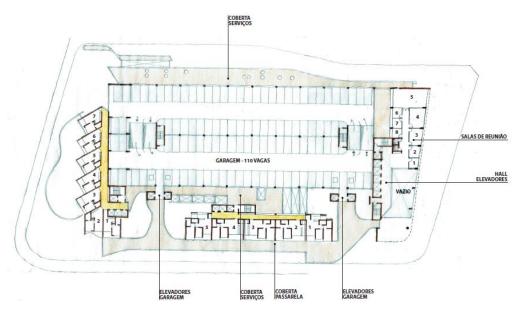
Planta Baixa do 1º pavimento da nova proposta. Fonte: Autor do Projeto
